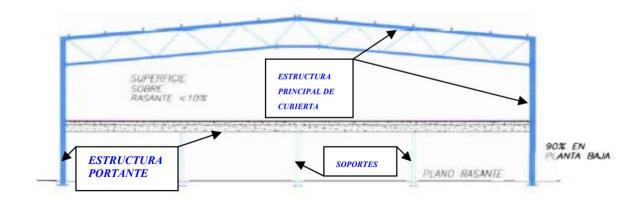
Elementos de Estructura Principal de Cubierta o Estructura Portante.
